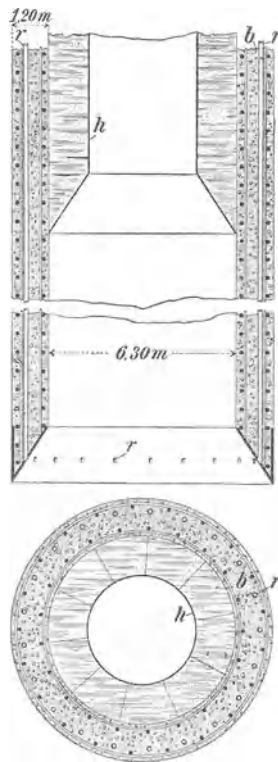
Senkschacht aus eisenbewehrtem Beton.
